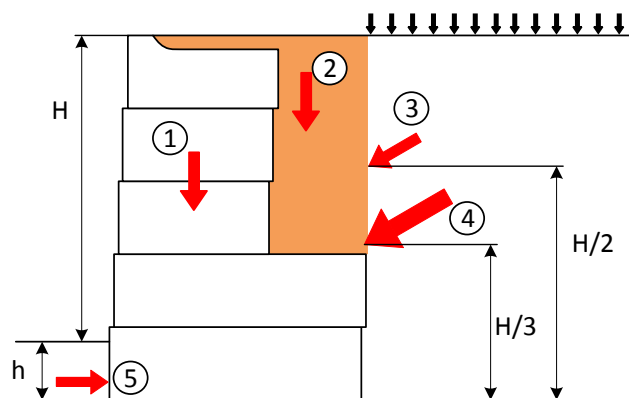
Общая схема воздействий на подпорную стену: 1 – вес стены; 2 – вес грунта на консольной части; 3 – давление от транспортной нагрузки; 4 – активное давление грунта; 5 – пассивное давление грунта
